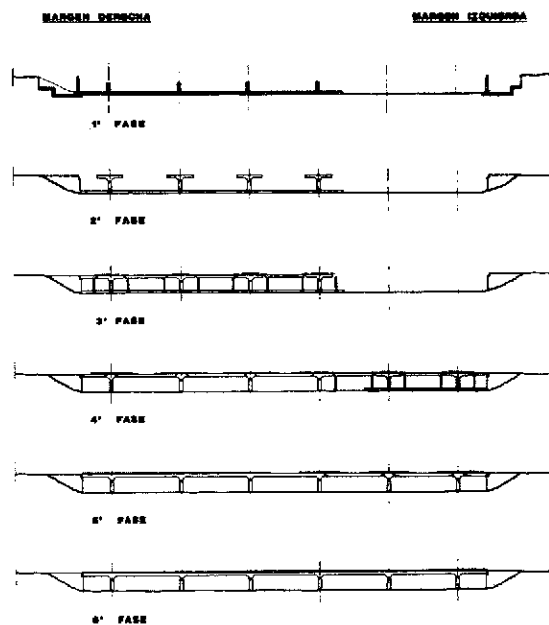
Puente de tablero continuo y sección variable. Proceso construcción.
